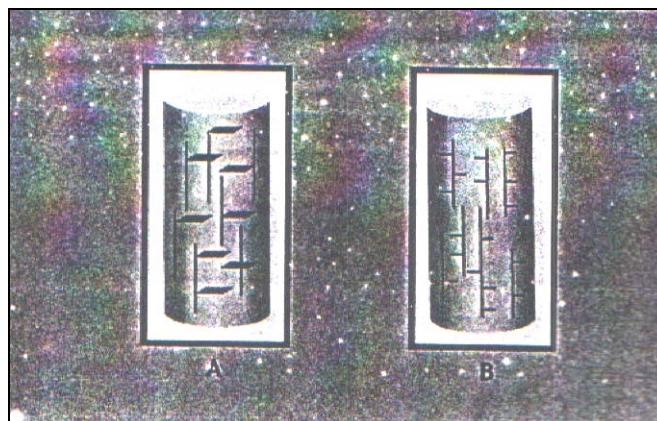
Representação de fissuras tipo *step fracture*. Fonte: SILVA, 2005
